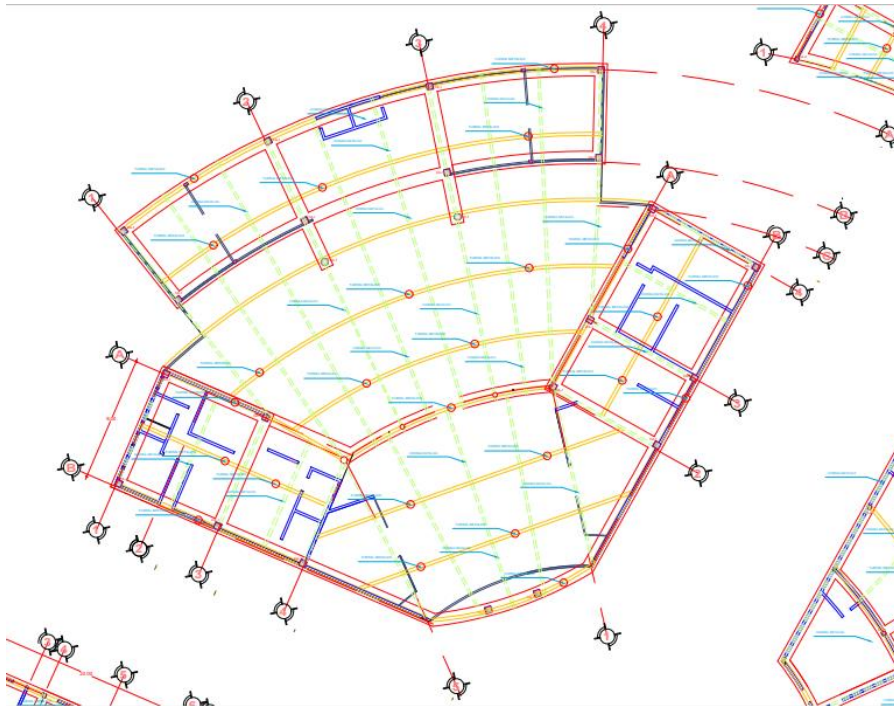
Plano estructura metálica restaurante - Elaboración propia
